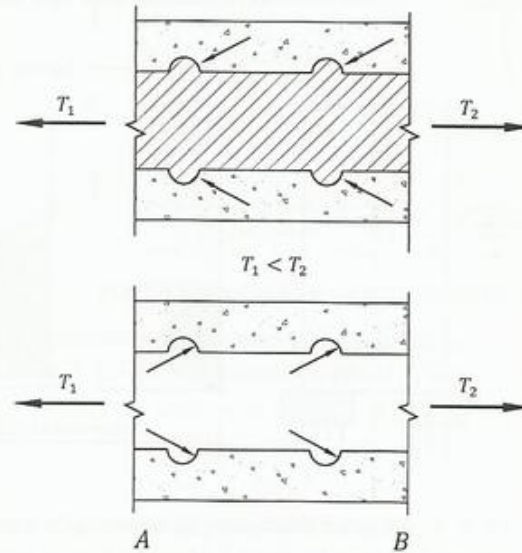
Transferencia de fuerzas entre el acero y concreto en barras estriadas
